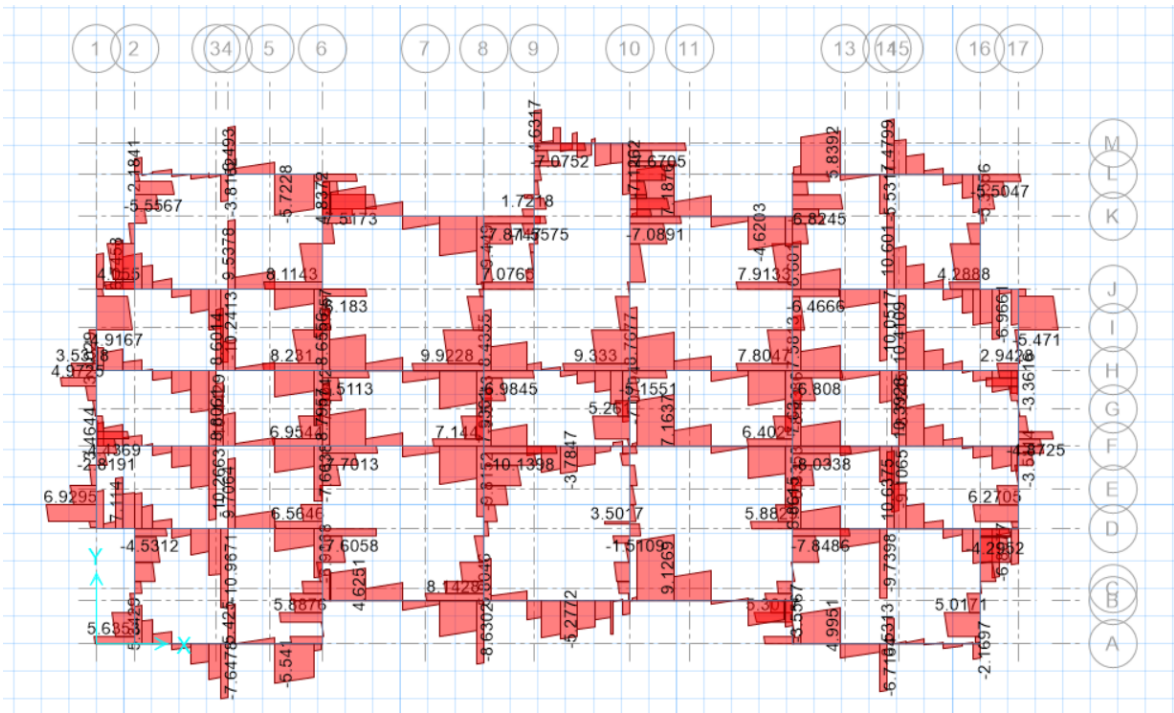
Distribución de acero transversal en vigas de cimentación Sistema Dual - Edificio Blesser. Fuente: Elaboración Propia.
